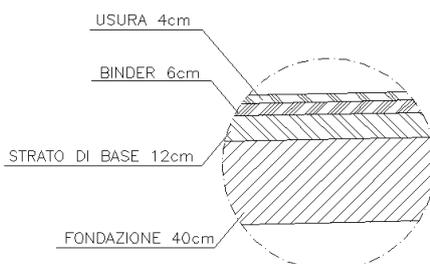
Pavimentazione di progetto per i tratti in allargamento
